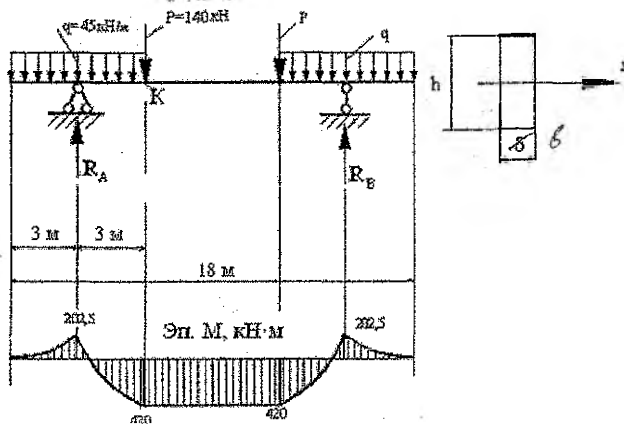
К расчету балки-стенки по балочной схеме (метод сопротивления материалов)
